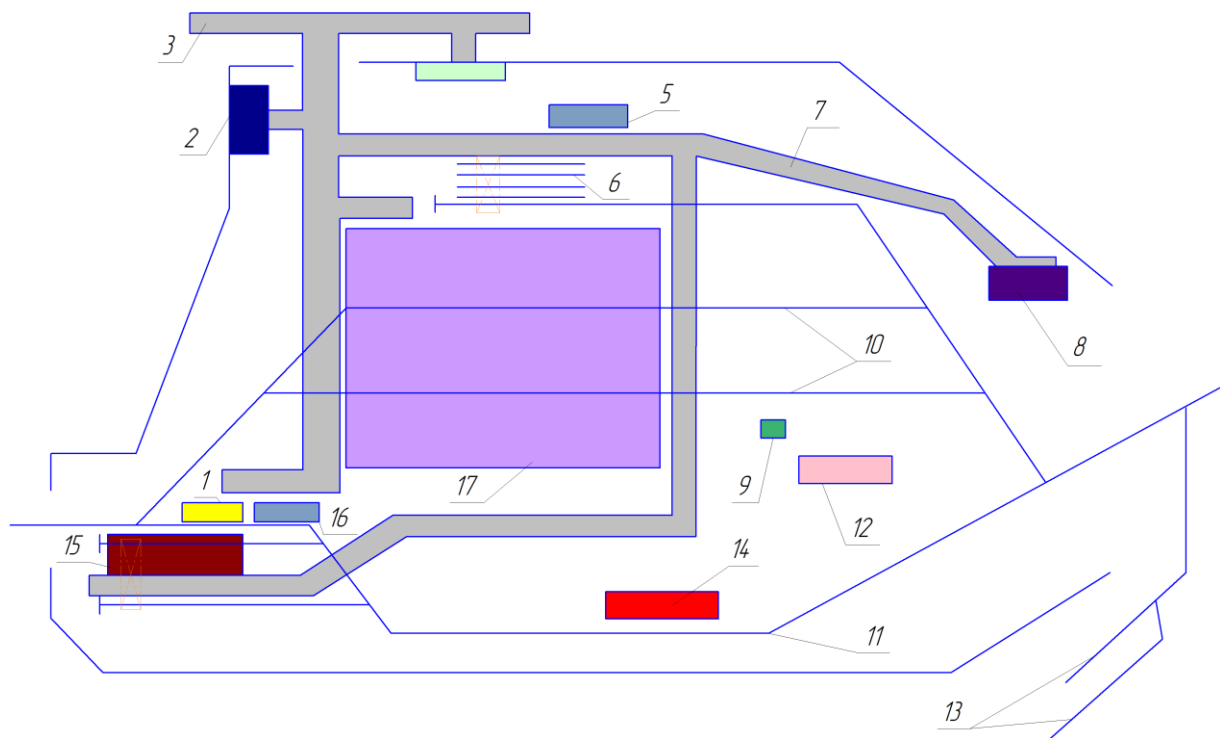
Схема генерального плану вантажного вагонного депо:
